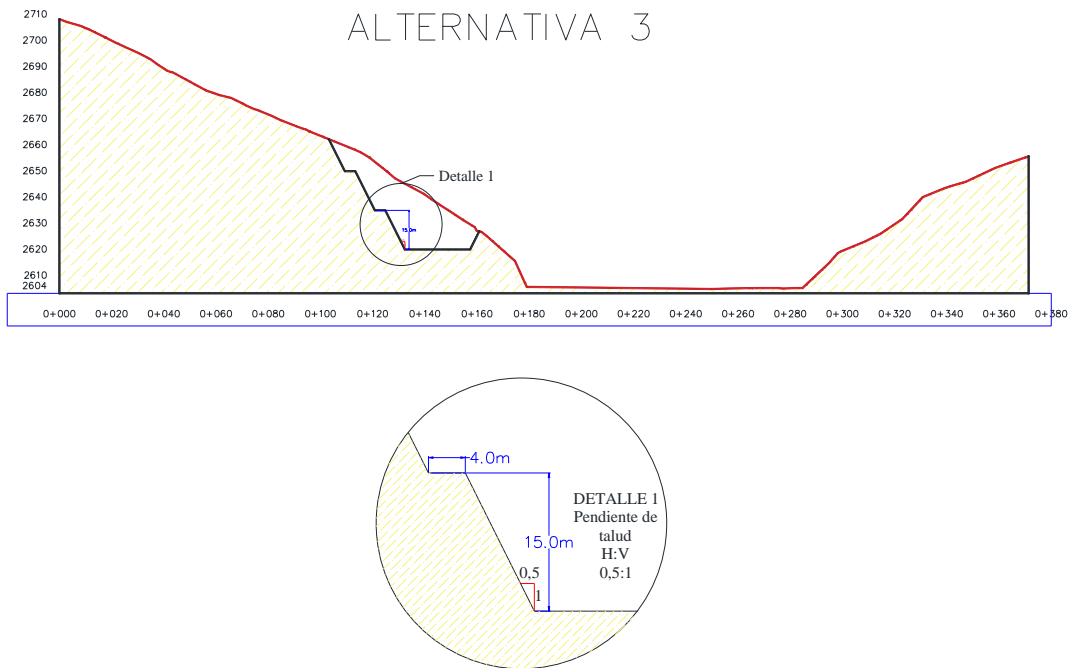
Alternativa 3, geometría de corte para trazado vial
